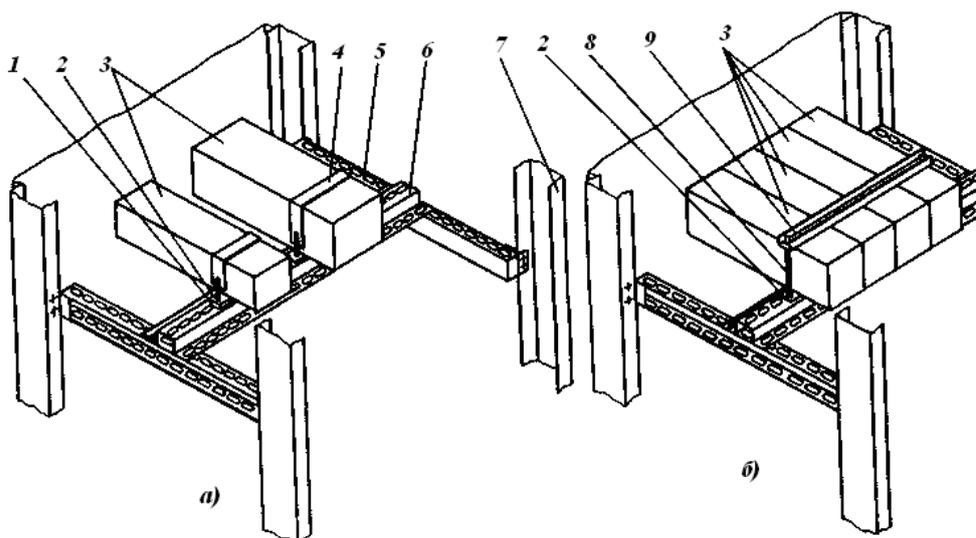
Пример крепления хвостовых частей приборов на каркасе щита: а — одиночная установка приборов; б — групповая установка; 1 — подставка; 2 — подкладка; 3 — прибор; 4 — хомут; 5 — швеллер боковой ШБ; 6 — опора; 7 — стойки каркаса щита; 8 — шпилька; 9 — швеллер Ш
